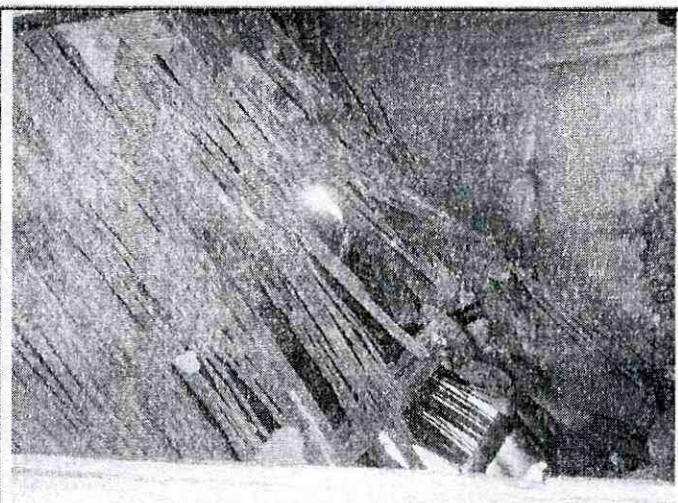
Colapso parcial de parte de la estructura soporte de la cubierta conformada por esterilla de guadua y madera debido al alto grado de pudrición que presenta dicha edificación .
